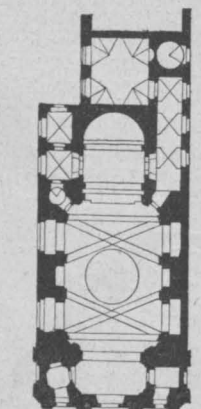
Grundriß der Waisenhauskirche, St. Maria de Mercede, IX. Bez.
